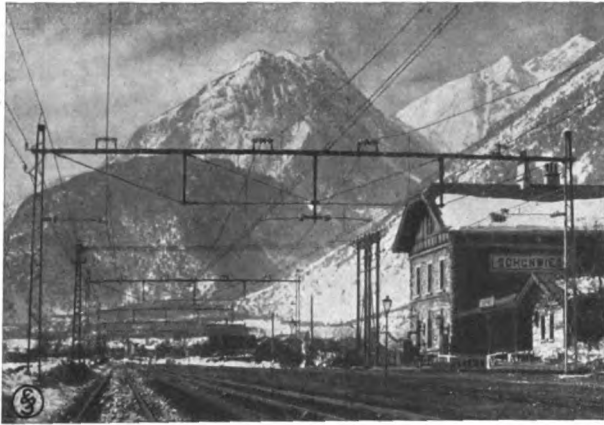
Leitungsverlegung im Bahnhof Schönwies mit Schaltgerüst.
